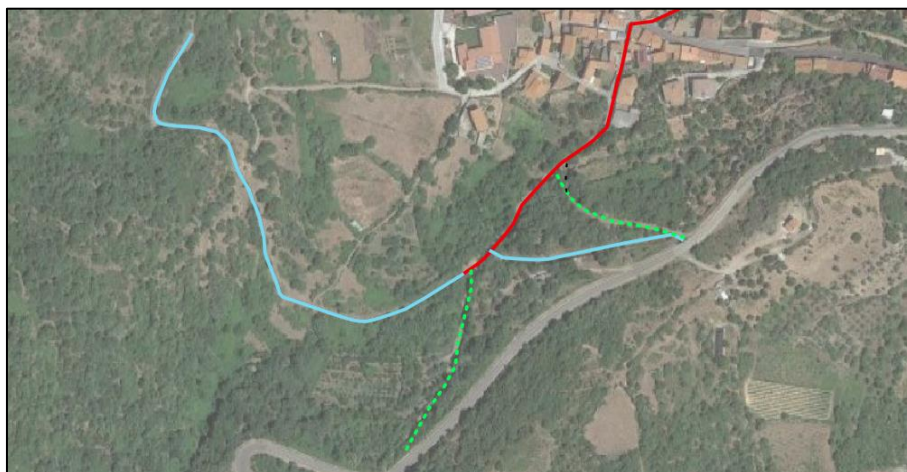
Localizzazione planimetrica degli interventi in verde tratteggiato
